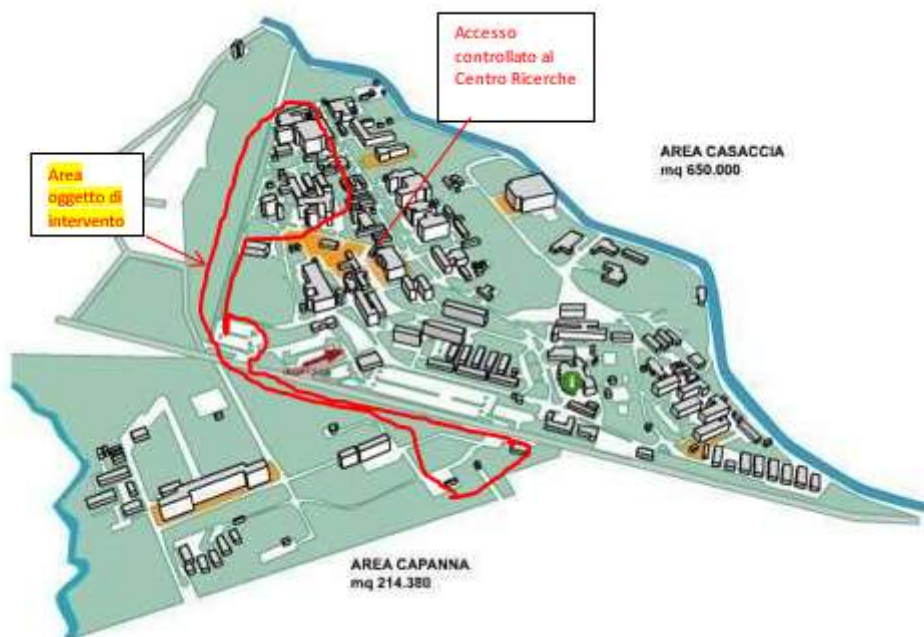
Rappresentazione planovolumetrica del C.R. Casaccia Casaccia.
